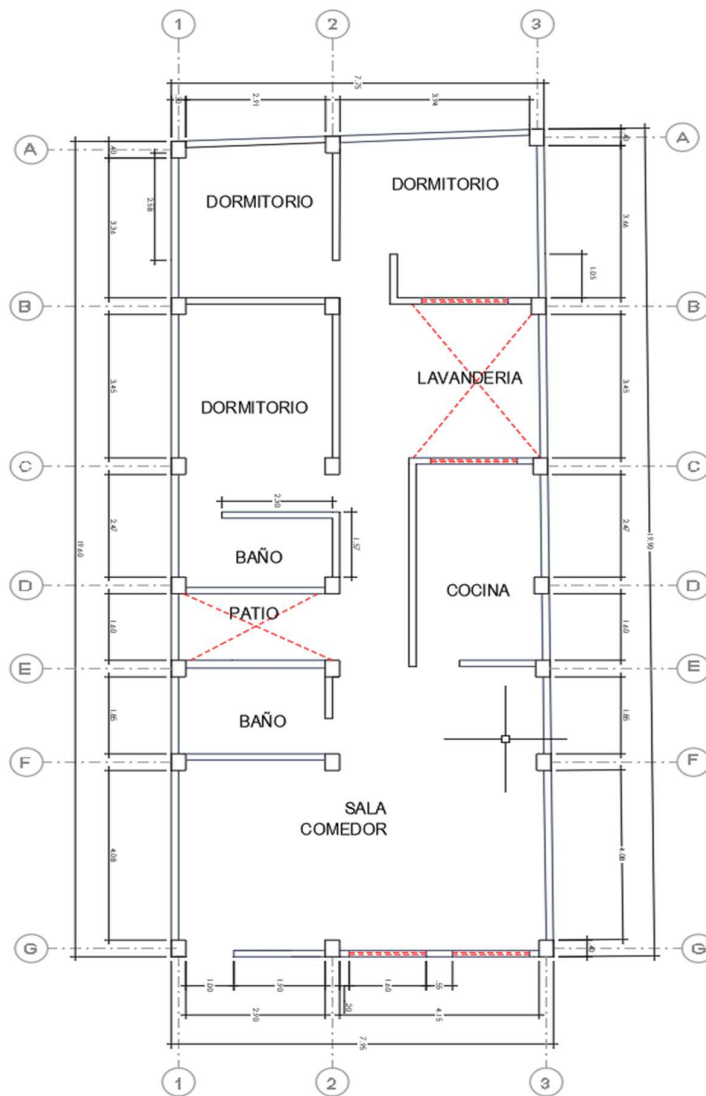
Configuración Geométrica en planta de la vivienda N°02
